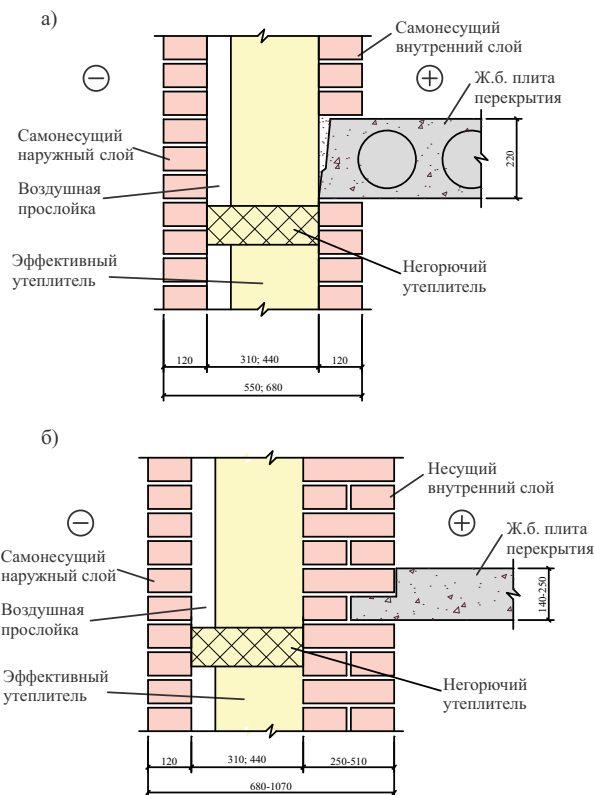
Узлы опирания плиты перекрытия на наружную стену из кирпичной кладки с вертикальными кирпичными диафрагмами: а – с самонесущим внутренним слоем (узел ба); б – с несущим внутренним слоем (узел бб)
